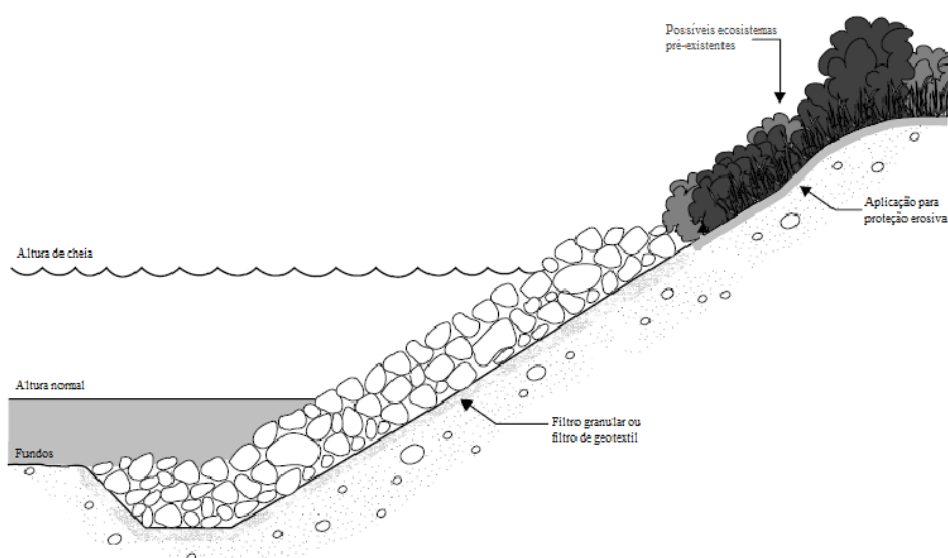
Corte transversal de um exemplo de implantação de enrocamento - adaptado de NCRS (1996).
